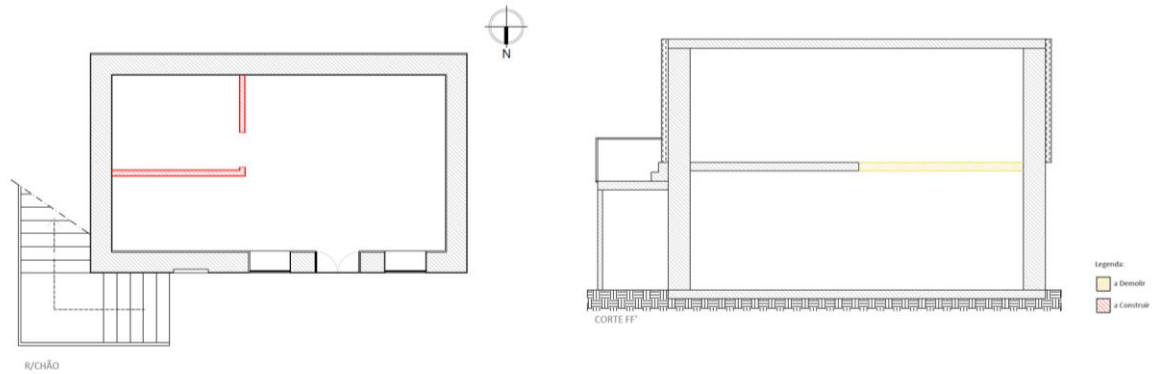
Planta de Alteração R/Chão e Corte com alteração do Piso 1, Alojamento Til.
